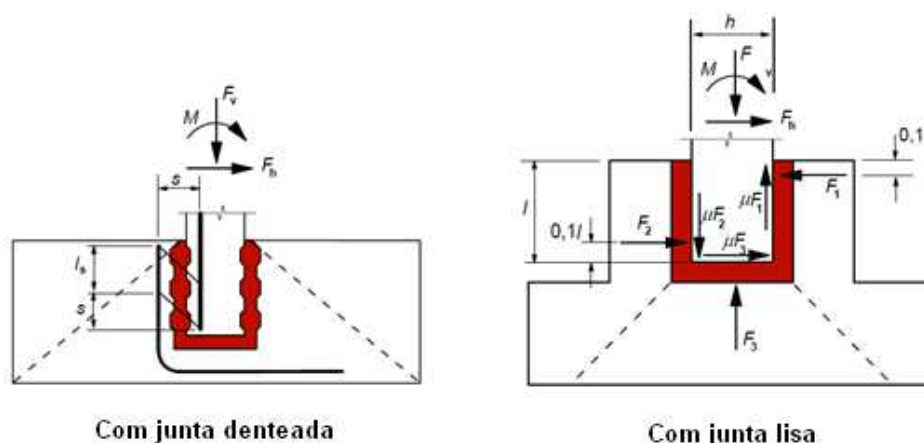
Fundações de encaixe (NP EN 1992-1-1, 2008)
